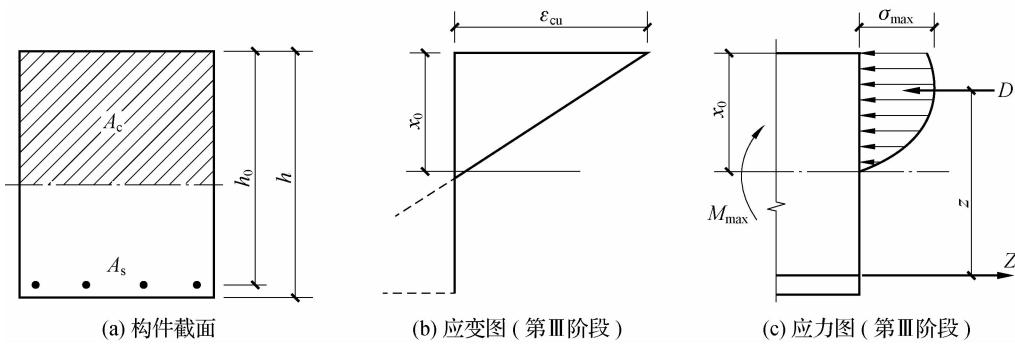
钢筋混凝土梁在破坏阶段的应力、应变图
